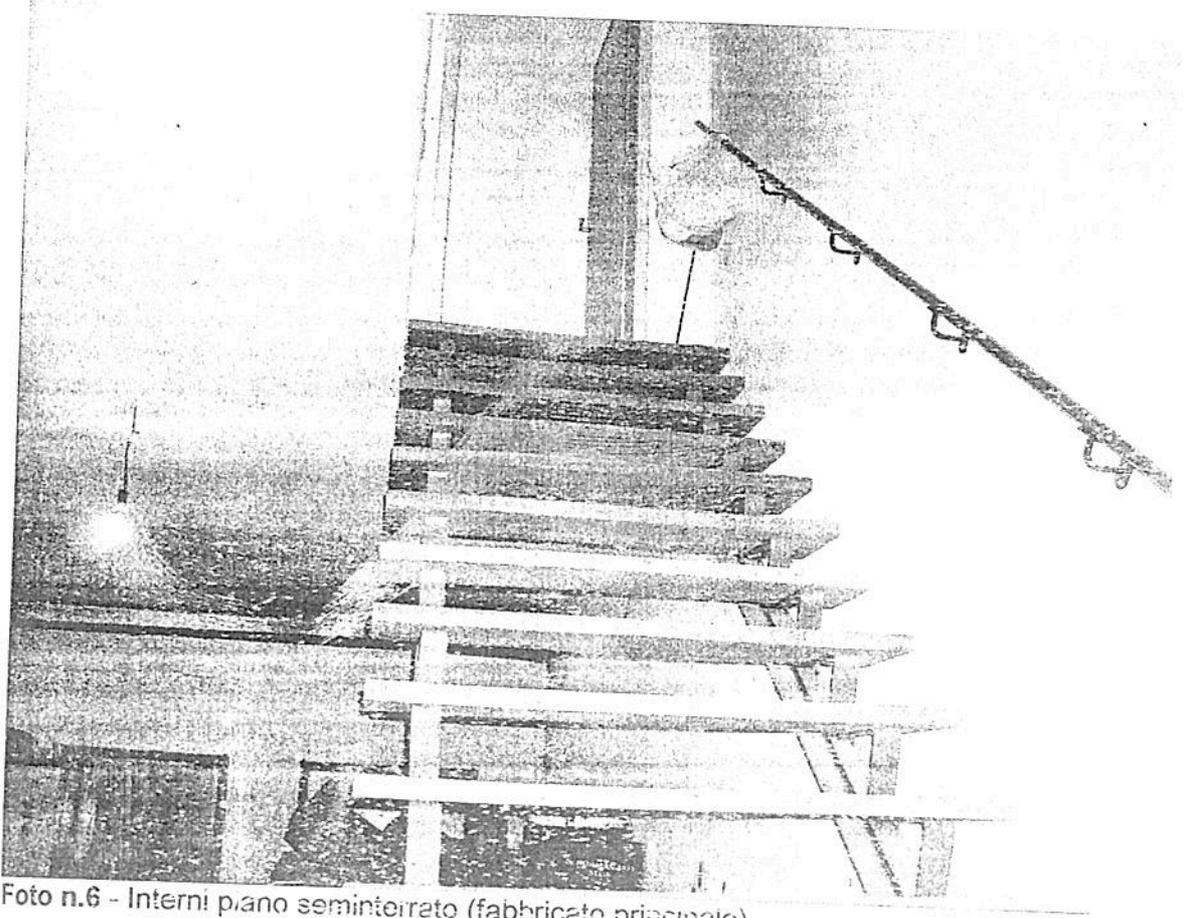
Interni piano seminterrato (fabbricato principale)
